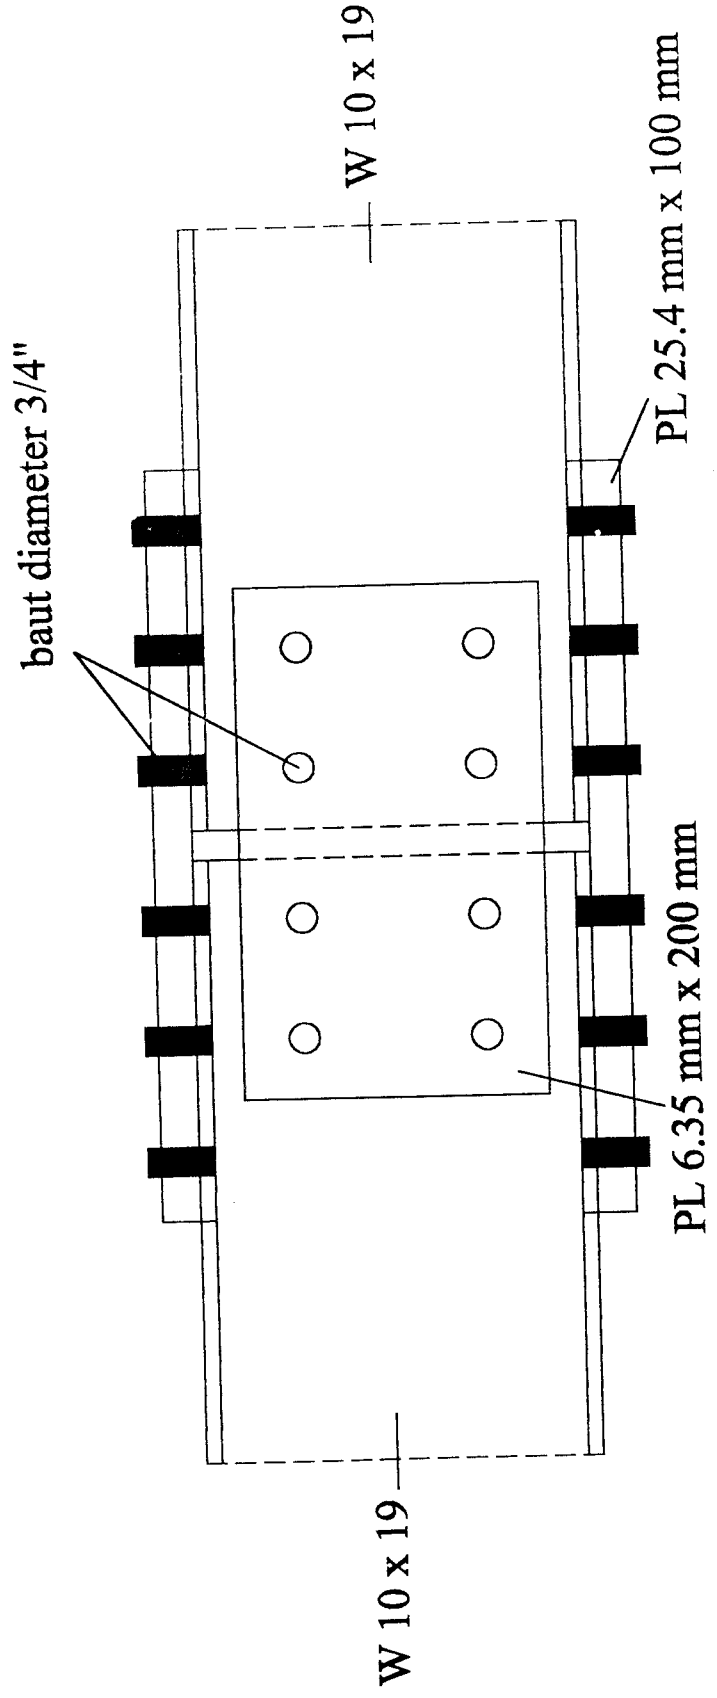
DETAIL SAMBUNGAN PADA JOIN LANTAI 1,5 PORTAL 6
